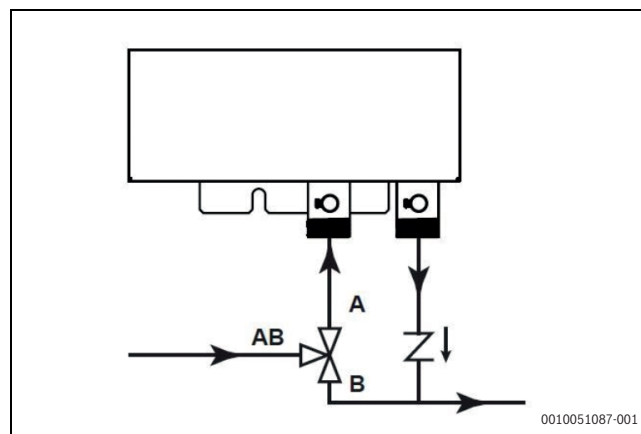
Vorgelagerte 3-Wege- oder 2-Wege-Installation
